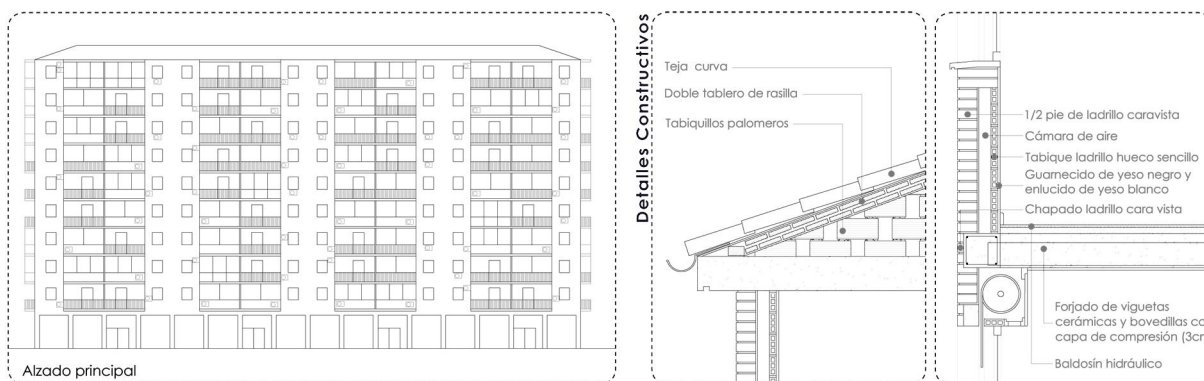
Alzado principal y detalles constructivos [Elaboración propia].
